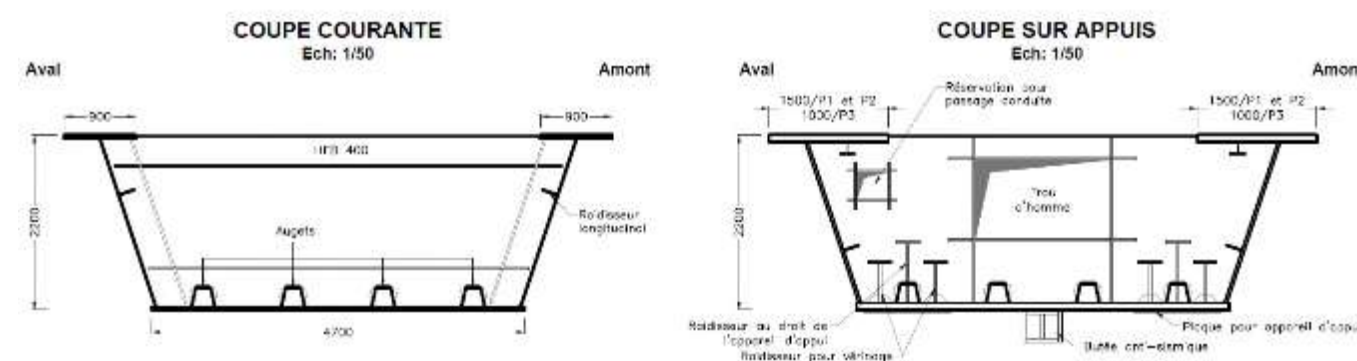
Coupe transversale du caisson métallique en zone courante et sur appuis (AVP, 2018)
